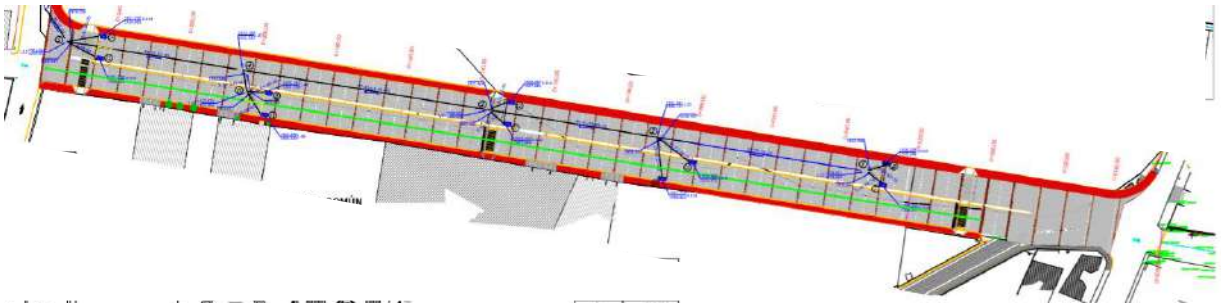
Red de drenaje pluvial en la calle Viznaga. Plano de drenaje pluvial de la calle.
